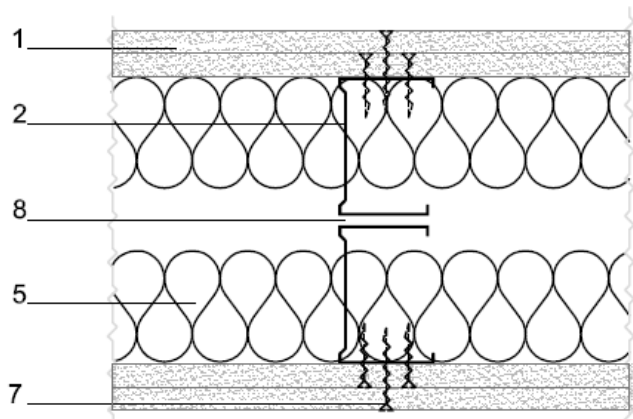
Sección horizontal de un tabique con subestructura doble y panelado simple arriostrado con cartelas.
